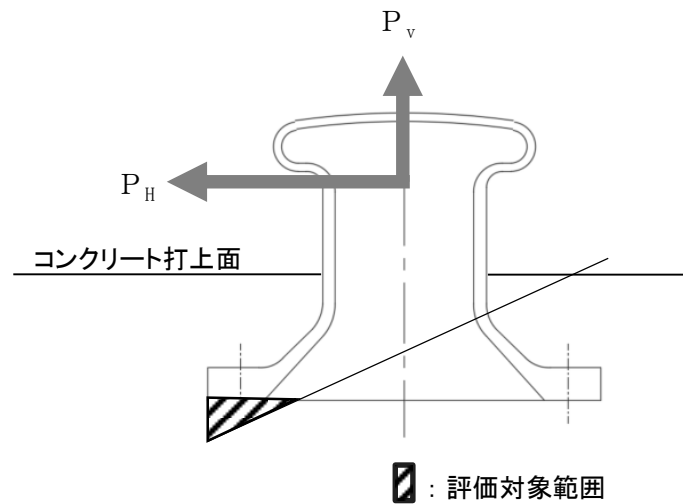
コンクリート（係船柱底板）のモデル図
